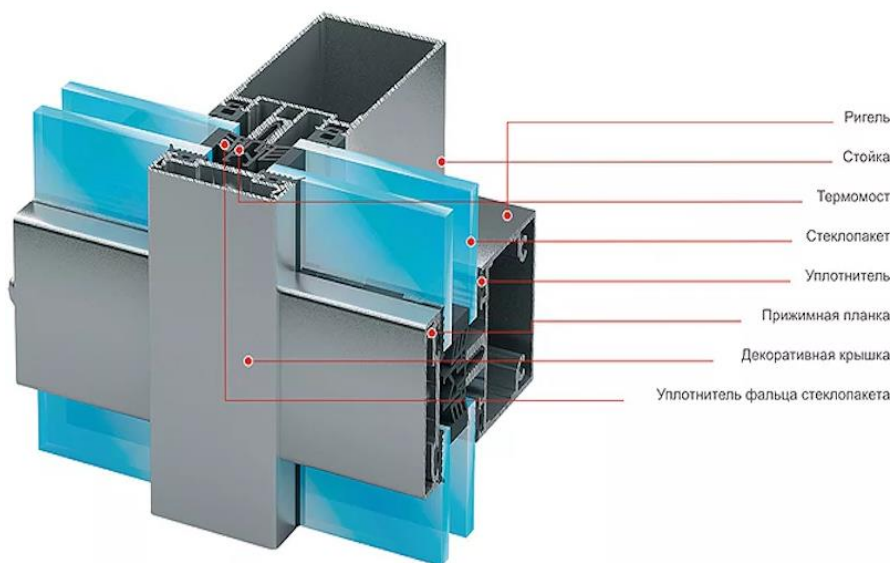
Пример конструкции светопрозрачных фасадов¹
